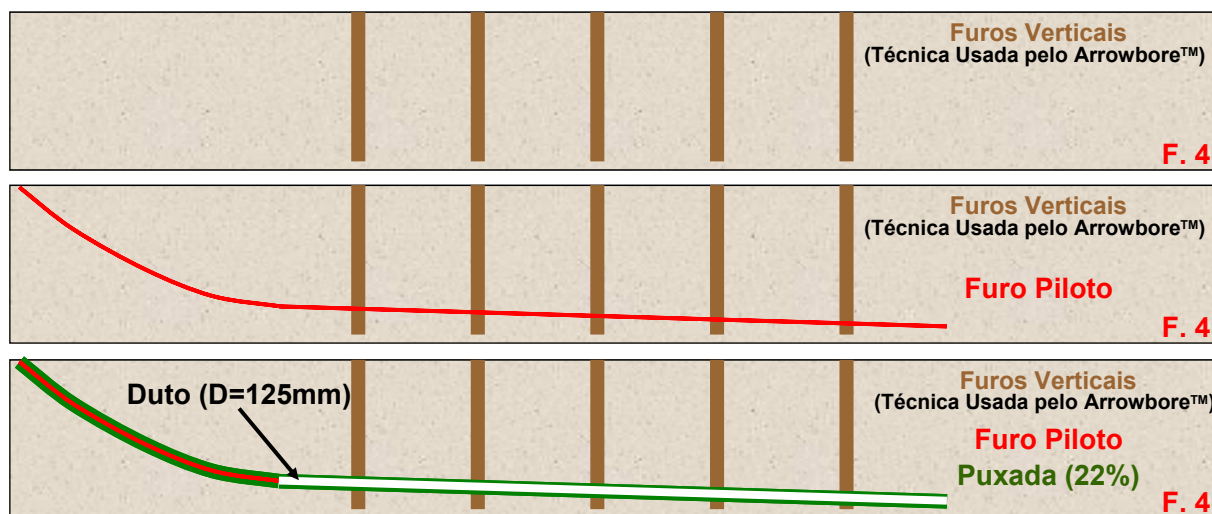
6 – Detalhe do processo construtivo empregado na instalação n°4
